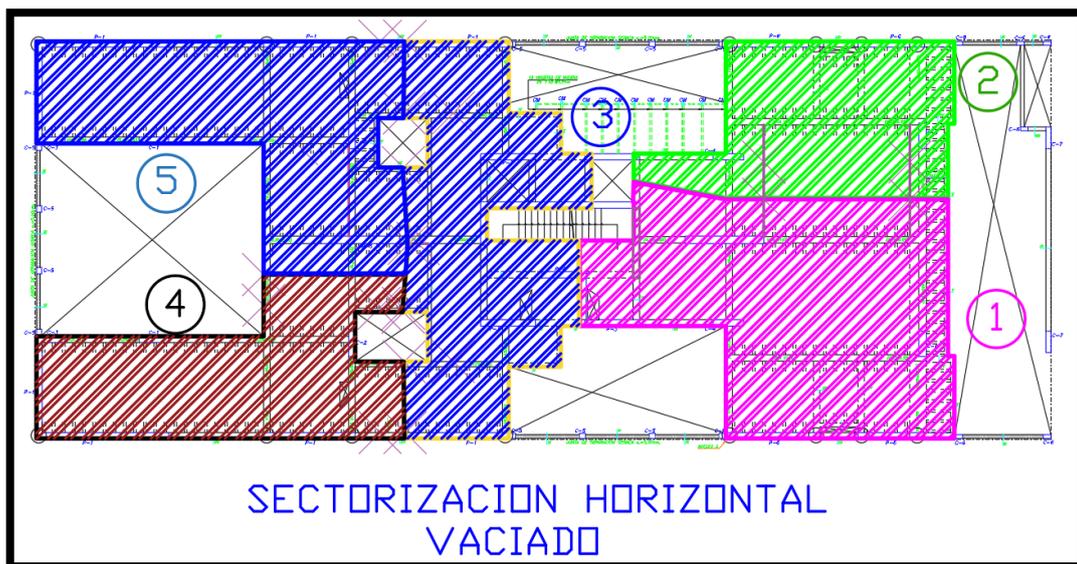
Sectorización de Elementos Horizontales para Concreto – Piso 2 al Piso 10.
